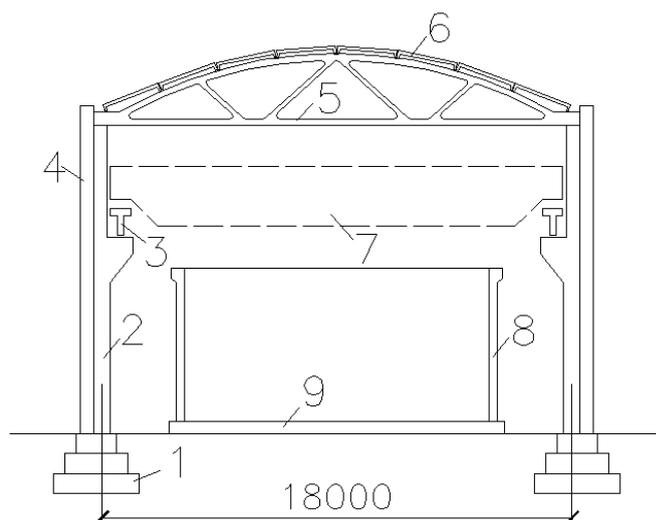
Поперечный разрез здания фильтров: 1 – фундамент; 2 – колонна крайнего ряда; 3 – подкрановая балка; 4 – стеновые панели; 5 – стропильная ферма; 6 – плита покрытия; 7 – мостовой кран; 8 – стеновые панели фильтра; 9 – днище фильтра
